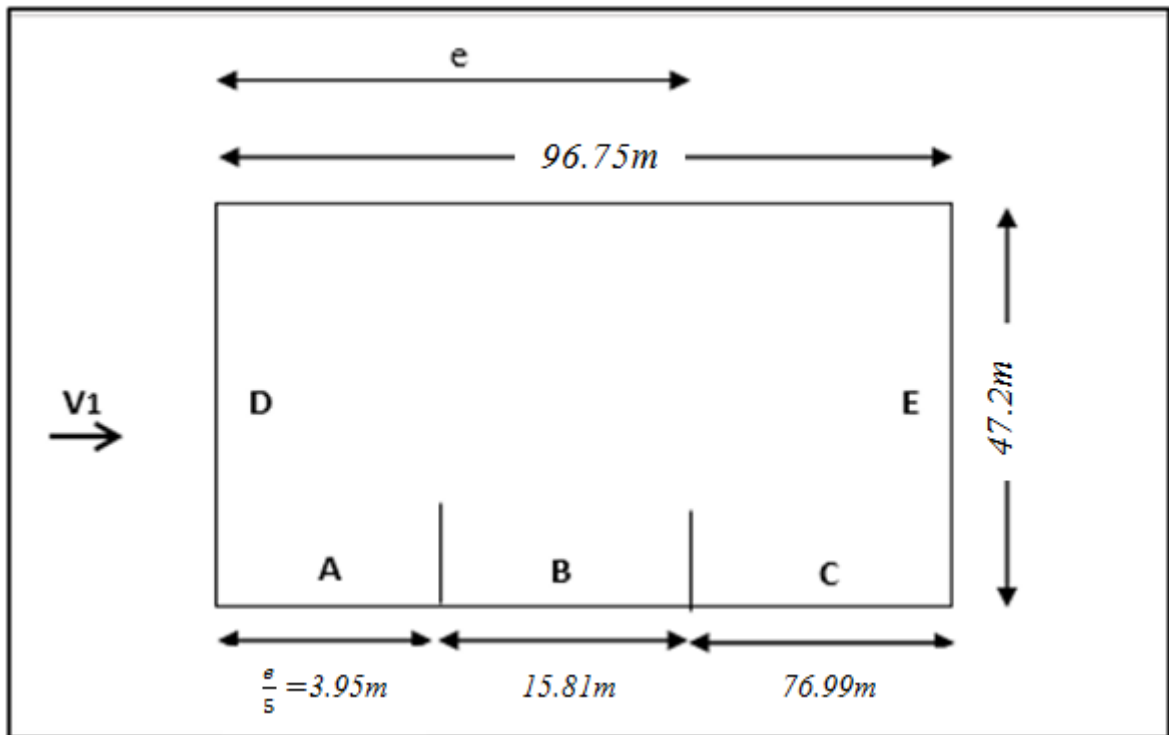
Vue en plan des zones de pression sur les parois verticales sens V_1
